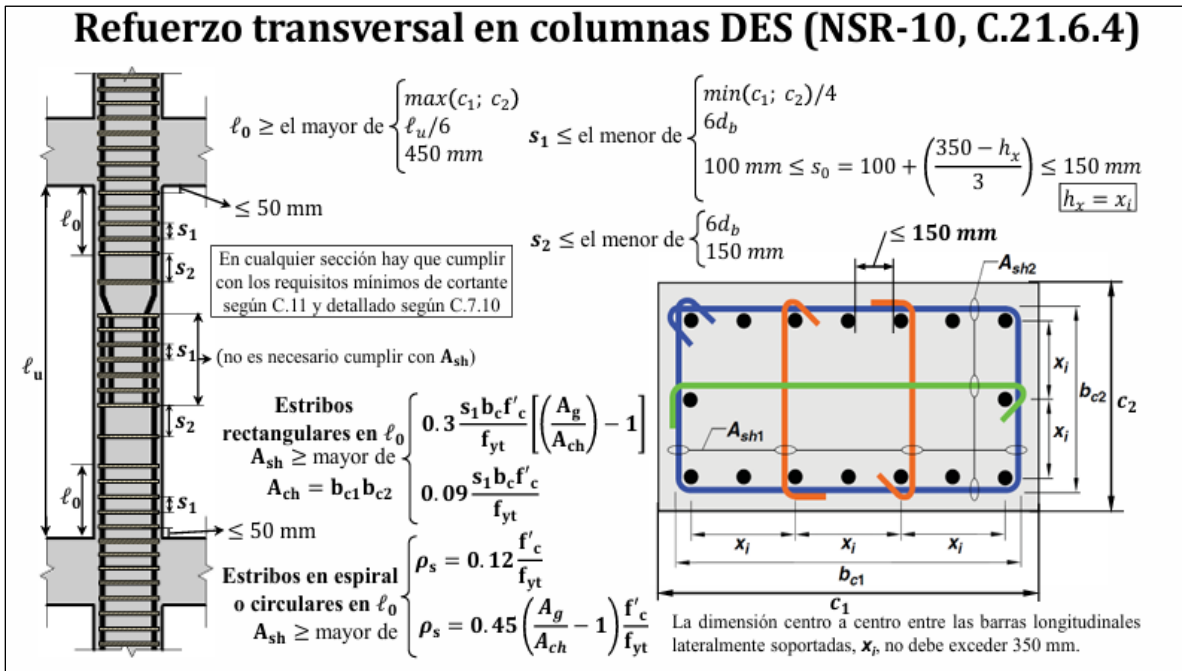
Configuración refuerzo transversal Columnas DES. Fuente: AIS 2010.
